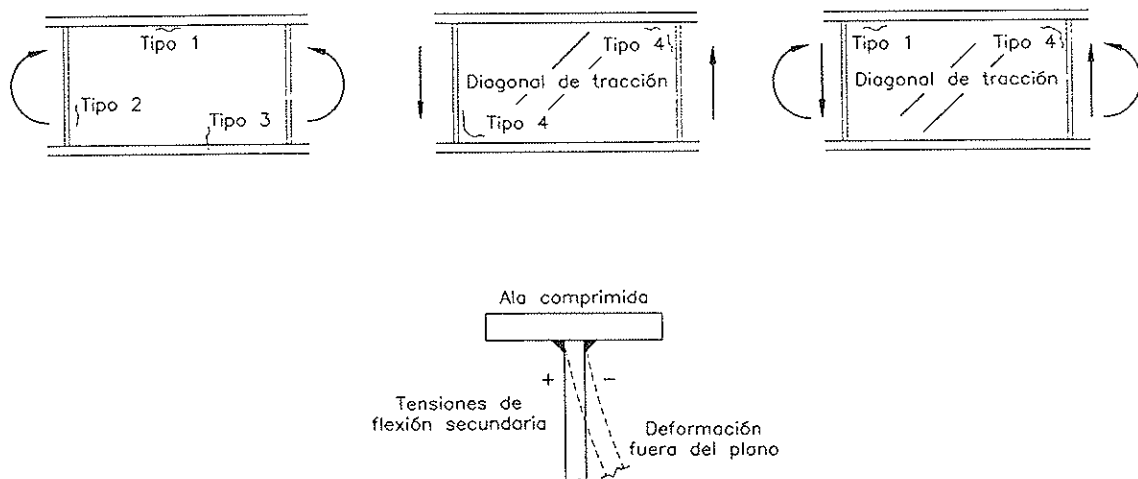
Fisuras de fatiga observadas en vigas armadas esbeltas [Okura et al (1993)].
